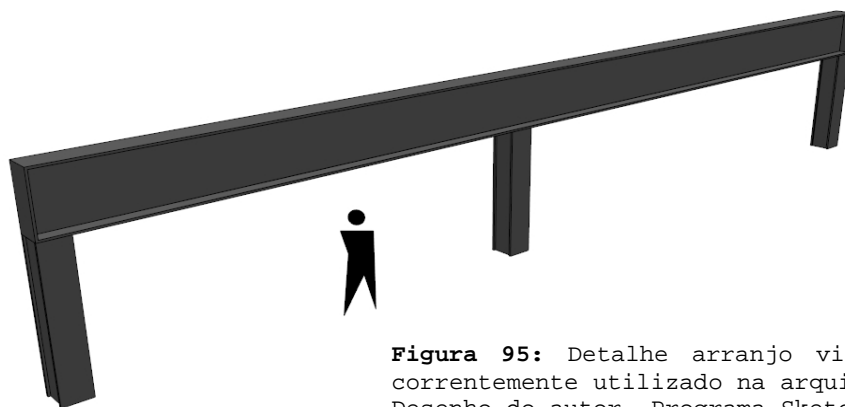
Detalhe arranjo viga e pilar correntemente utilizado na arquitetura. Desenho do autor. Programa SketchUp.
